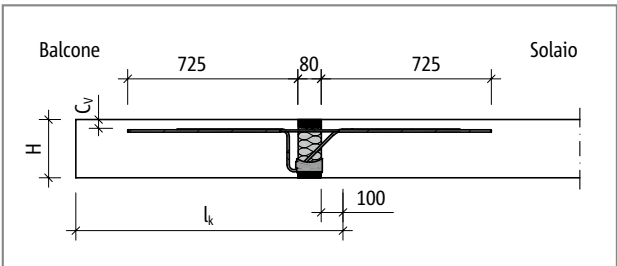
Schöck Isokorb® T tipo KL-M8 - M12: schema statico
